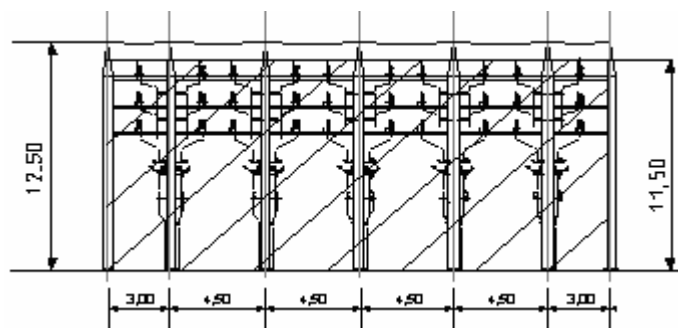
Sección 4. Pórtico en 34,5 kV.
